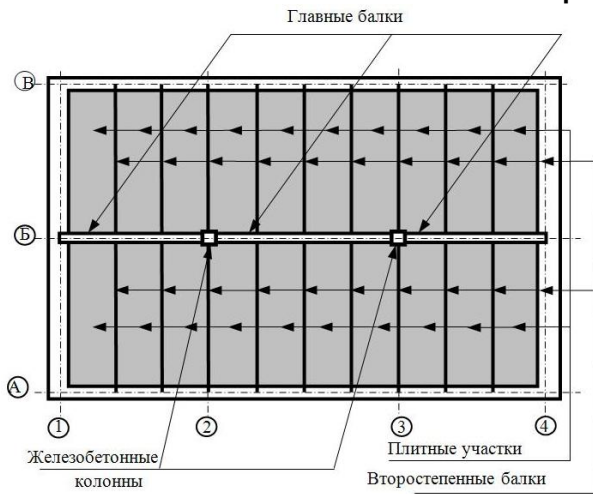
Схема раскладки балок монолитного железобетонного перекрытия
